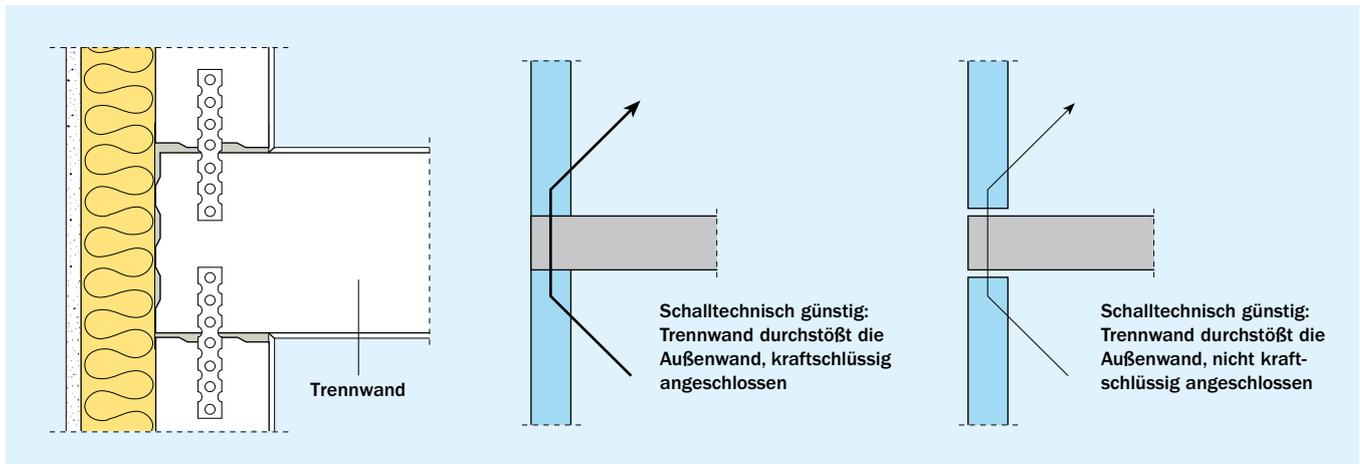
T-Stoß: Trennwände durchgehend, flankierende Wände stumpf angeschlossen
